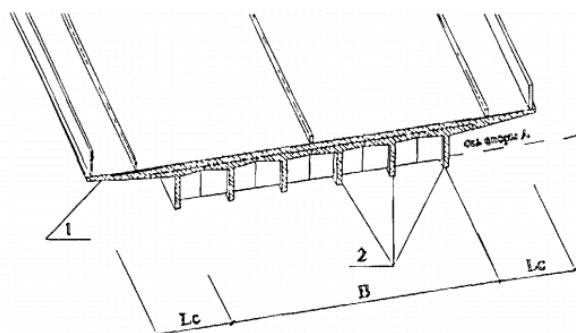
Схема реконструкции пролетного веса строения моста накладной монолитной сталефиброжелезобетонной плитой:
